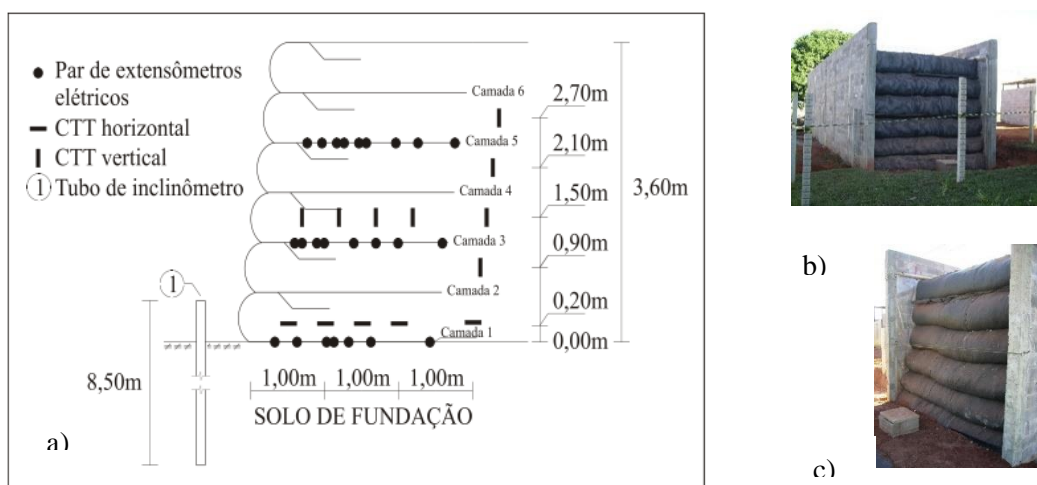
Muros experimentais analisados: (a) Instrumentação utilizada; (b) Vista da face do Muro 1; (c) Vista da face do Muro 2 (Santos 2011)
